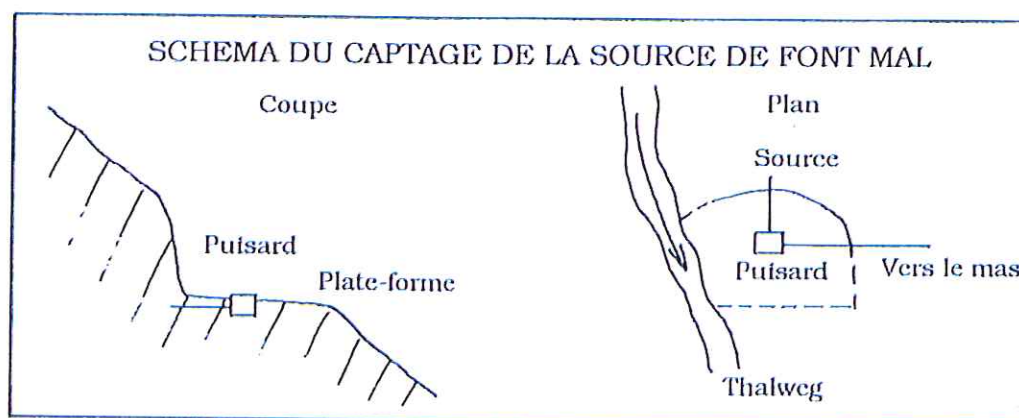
plan et coupe schématiques du captage de la source « Font Mal ».
